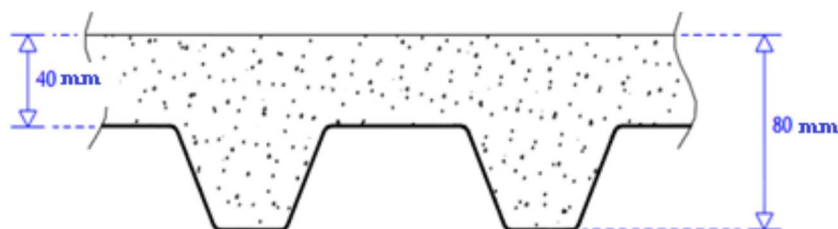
Espessuras mínimas [mm] da secção transversal de uma laje sem funções de contraventamento [19]
